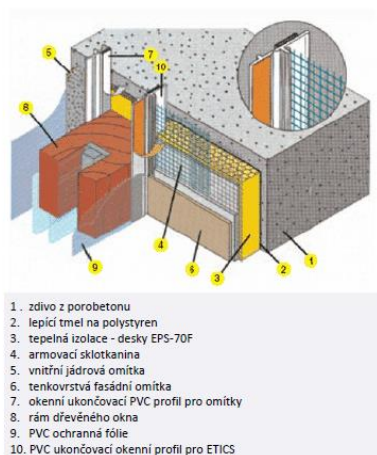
Detail aplikace výztužné síťoviny u fasádních otvorů
